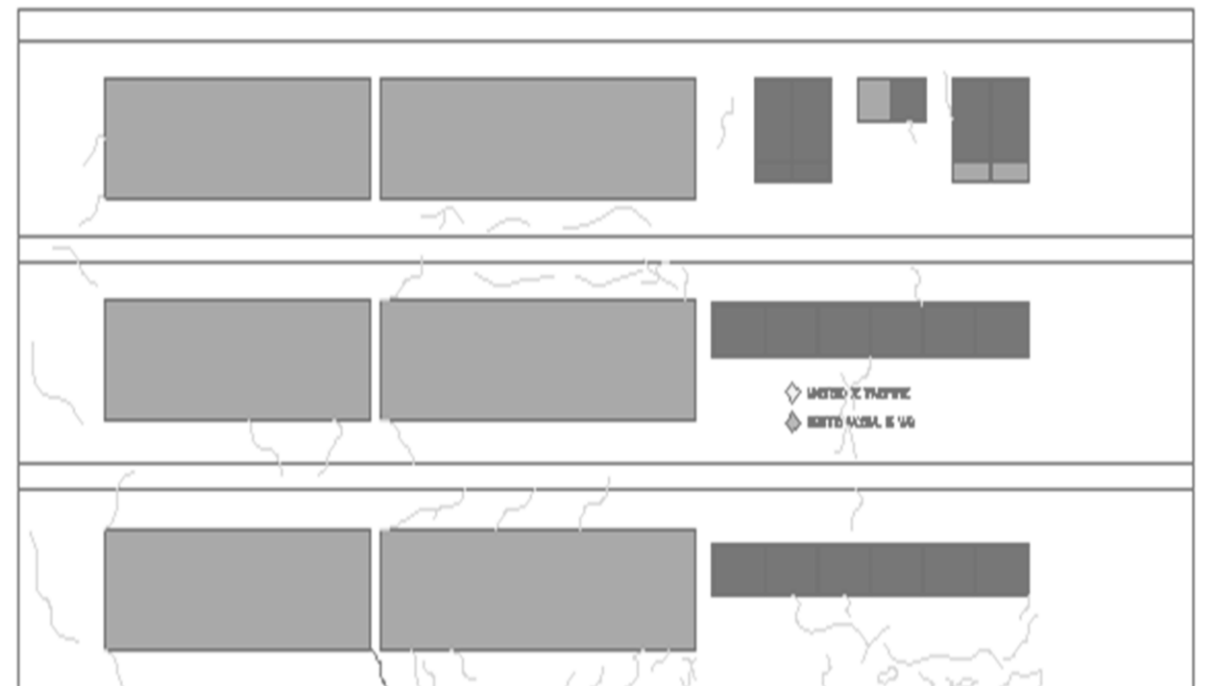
Esquema Grietas Fachada 2. Realizada por el autor.
